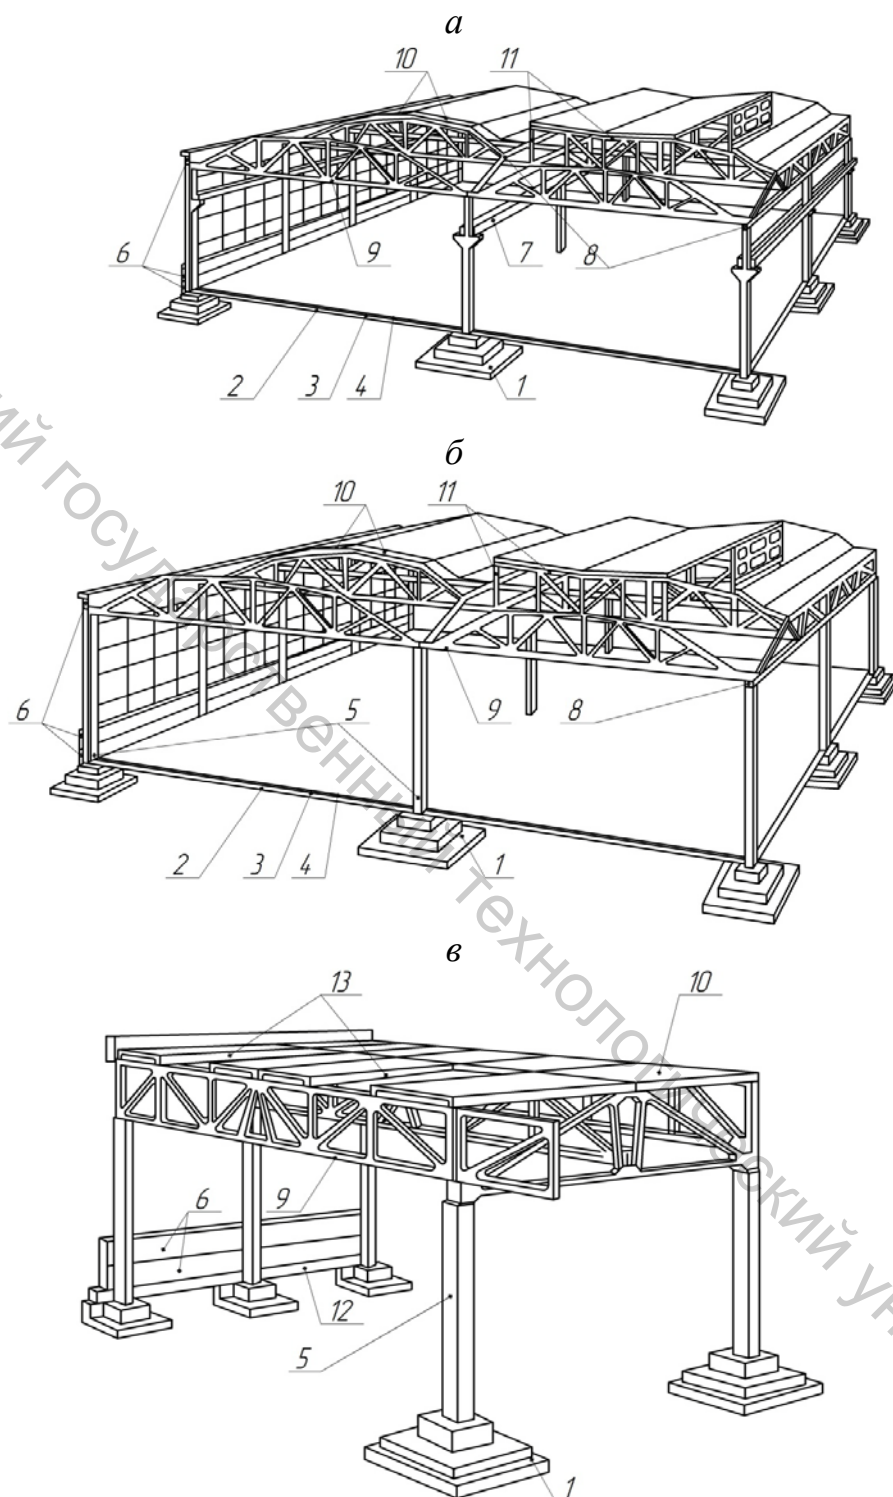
Пролёты и конструктивные элементы зданий с полным каркасом: а – крановые пролёты; б – бескрановые пролёты со скатной кровлей и светоаэрационными фонарями; в – бескрановые пролёты с плоской кровлей и световыми плафонами; 1 – фундамент; 2 – бетонная подготовка; 3 – стяжка; 4 – покрытие пола; 5 – колонны; 6 – стеновые панели; 7 – подкрановая балка; 8 – подстропильные фермы; 9 – стропильные фермы; 10 – крупнопанельный настил; 11 – стальная рама фонаря; 12 – фундаментная балка; 13 – места для установки световых плафонов
